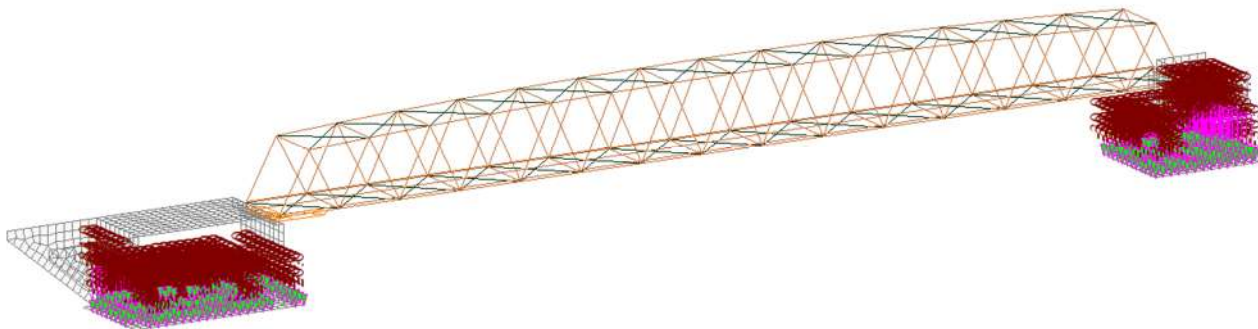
Ricoprimento del terreno sulle platee di fondazione
